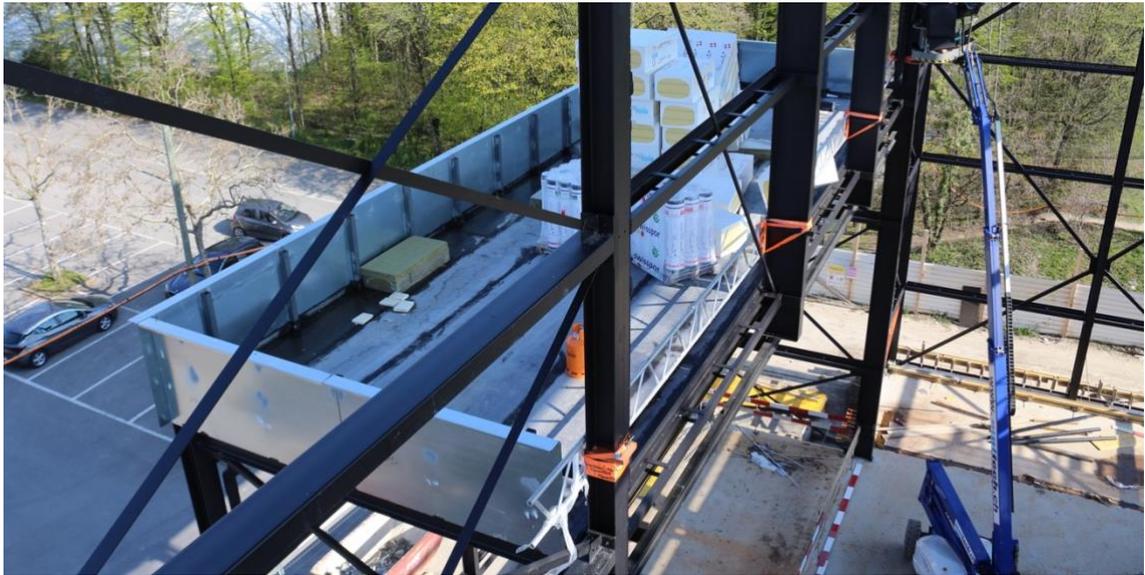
La toiture qui ne sera pas végétalisée du fait de son accessibilité restreinte (Yann Duchoud)
